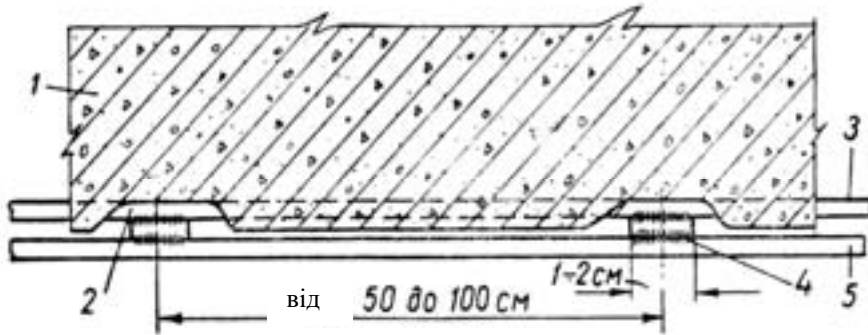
Спосіб кріплення додаткової повздовжньої арматури: 1 – плита перекриття; 2 – місце оголення існуючої арматури; 3 – існуюча повздовжня арматура; 4 – коротун; 5 – додаткова повздовжня арматура.
